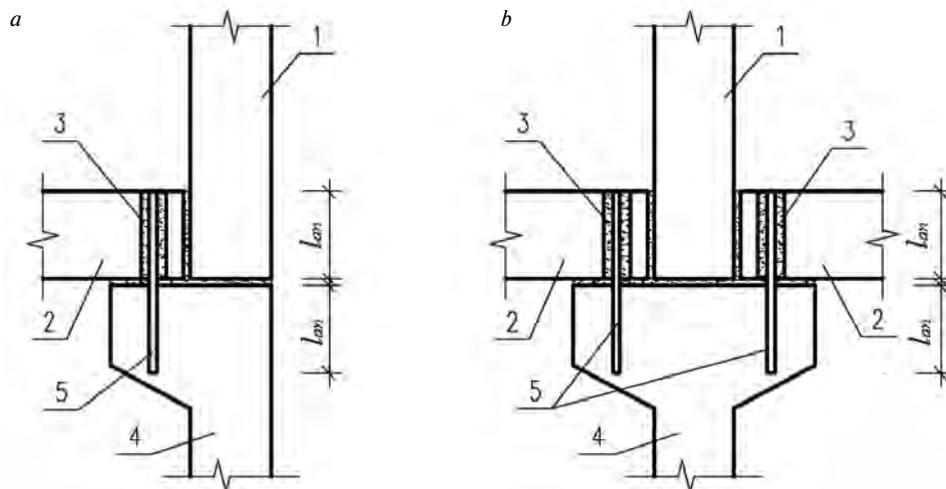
Принципиальные соединения сборных элементов плит и стен с применением стыков штепсельного типа в крупнопанельных конструктивных системах: а – контактный стык с односторонним опиранием плит; б – то же с двухсторонним опиранием плит; 1 – сборная стенная панель; 2 – сборная плита перекрытия; 3 – канал в бетоне; 4 – сборная стенная панель с консолью; 5 – арматурный или стальной выпуск
